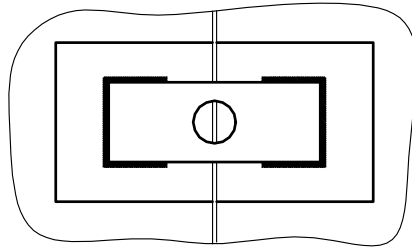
Chapa furada soldada proposta para a ligação [1]
